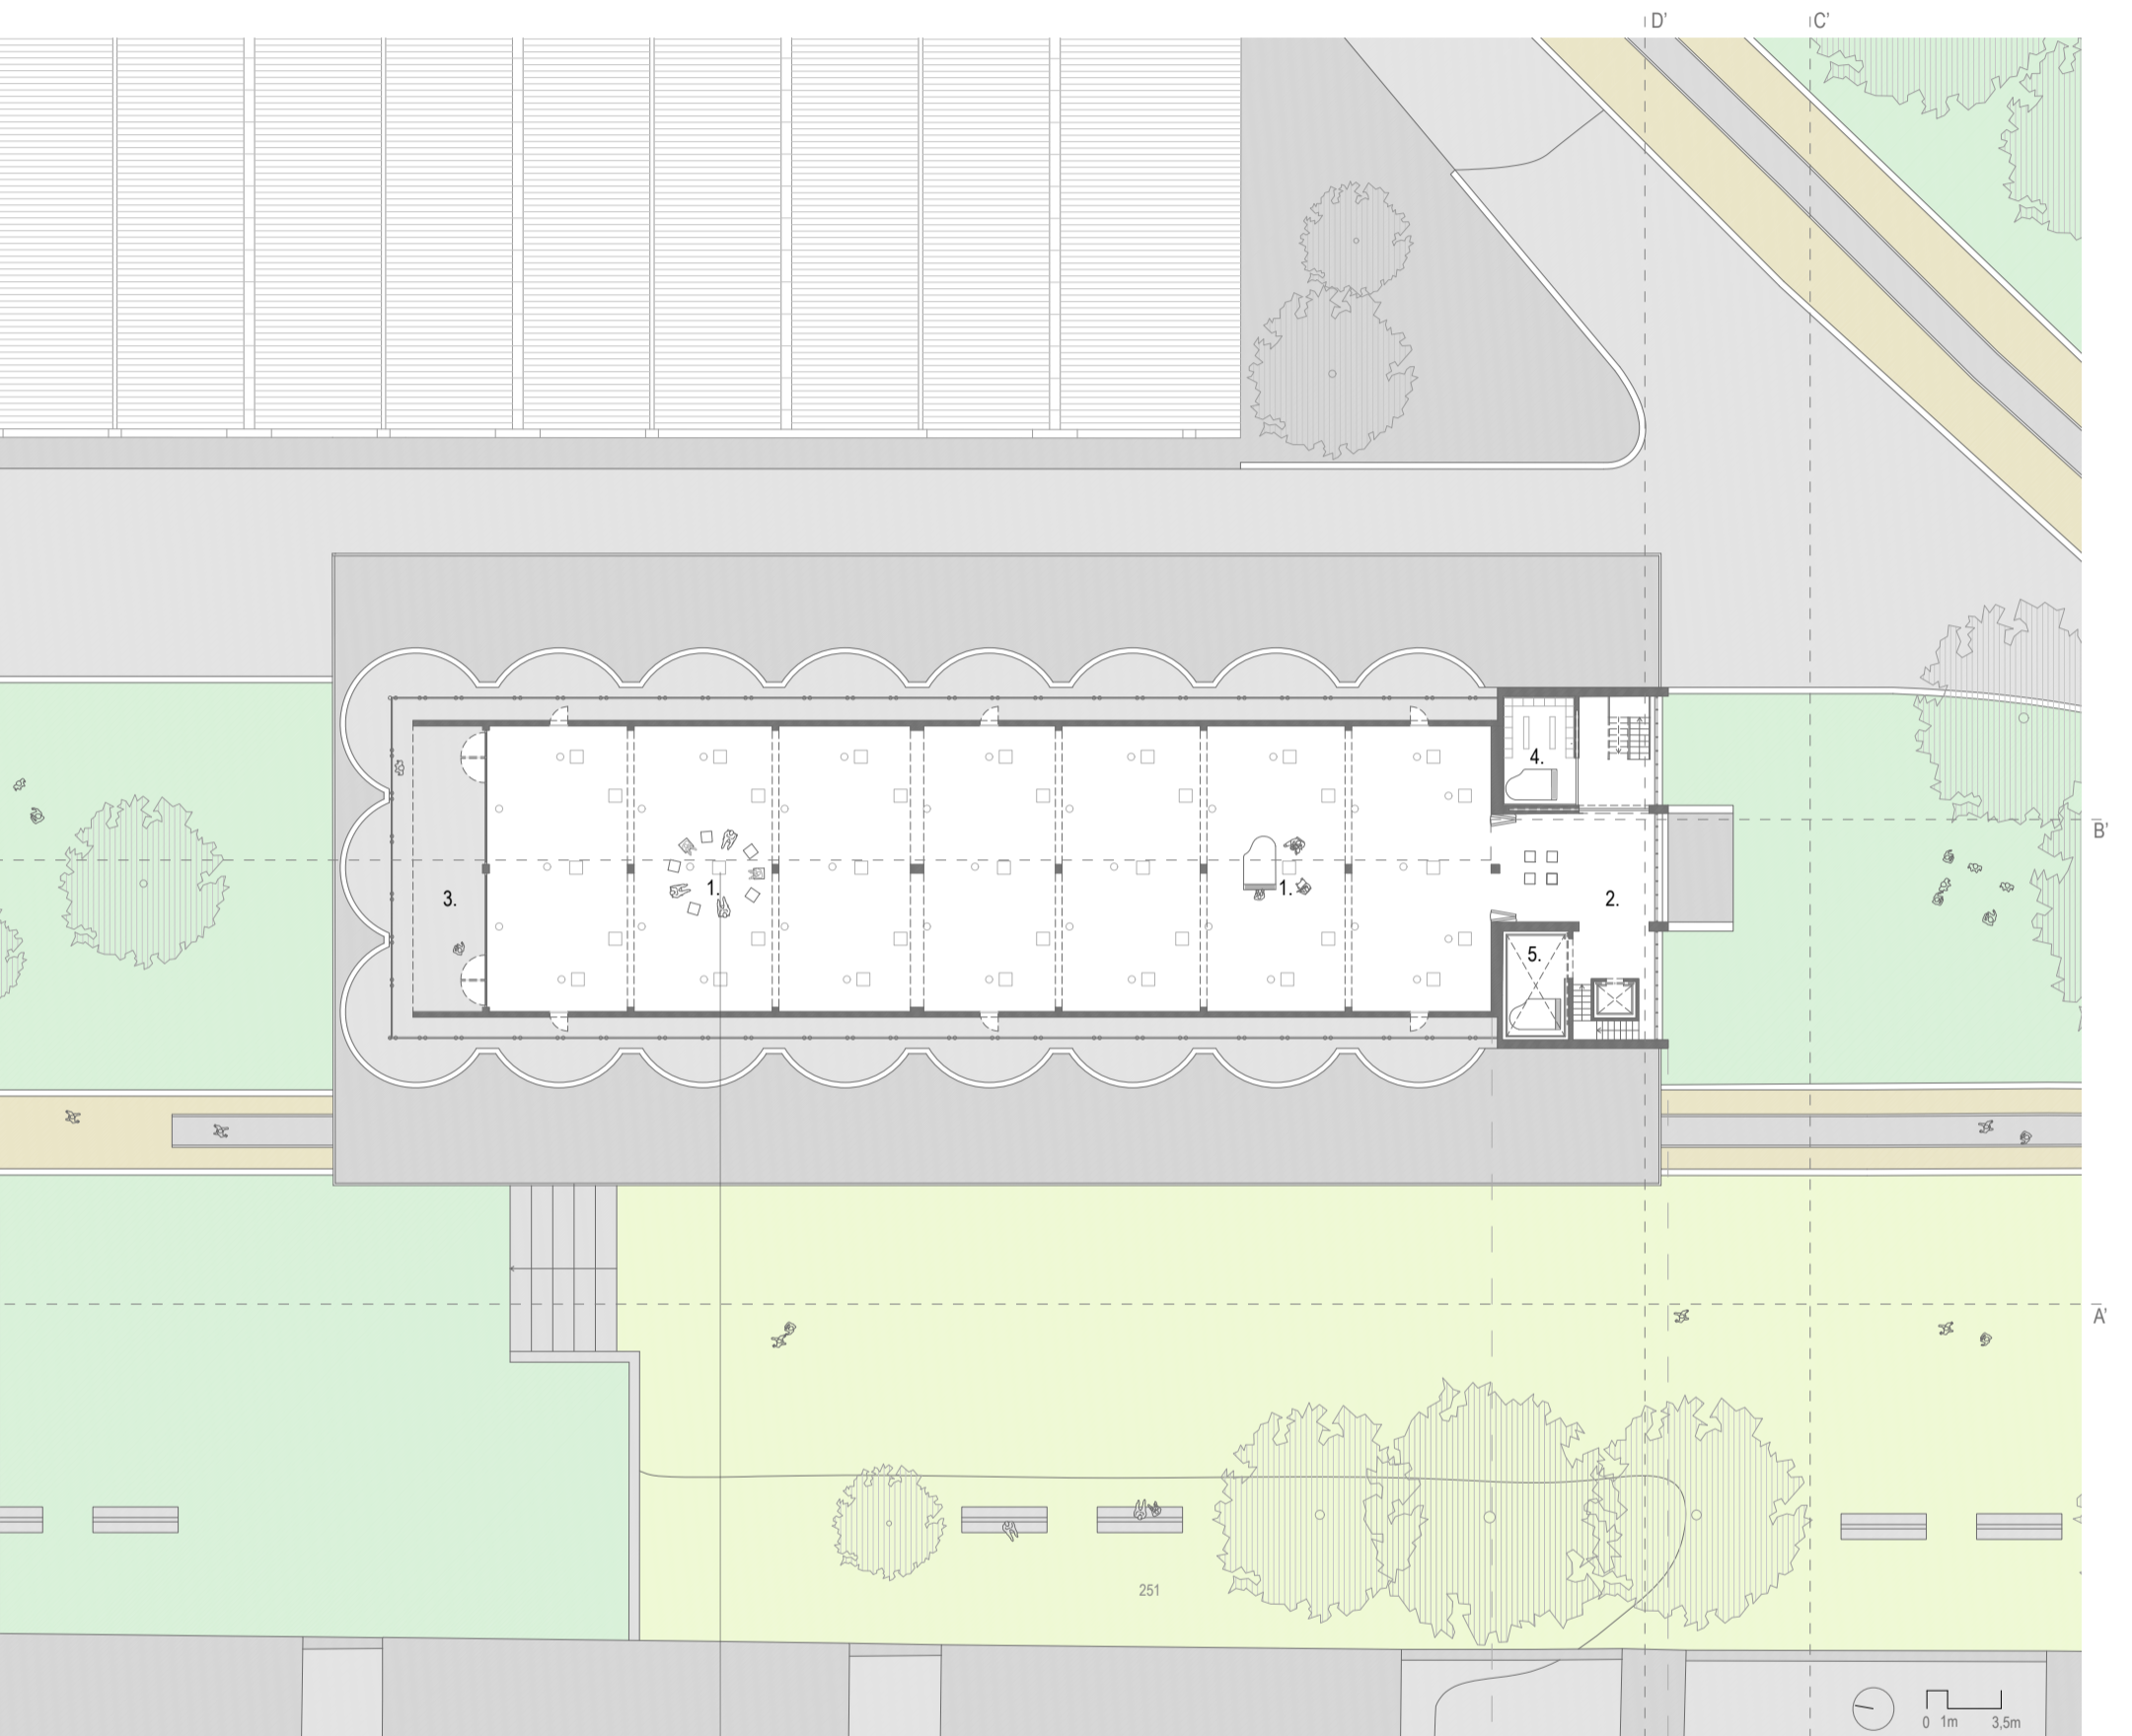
Planta piso 7. Proposta de intervenção, desenho do autor.
